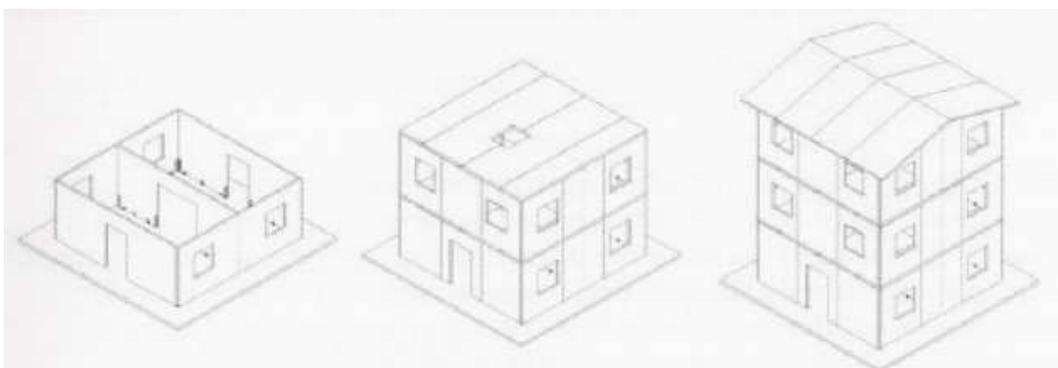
Fasi di costruzione dell'edificio a 3 piani.
